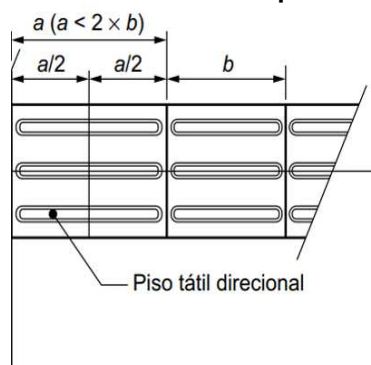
Piso tátil a ser instalado no interior da edificação
